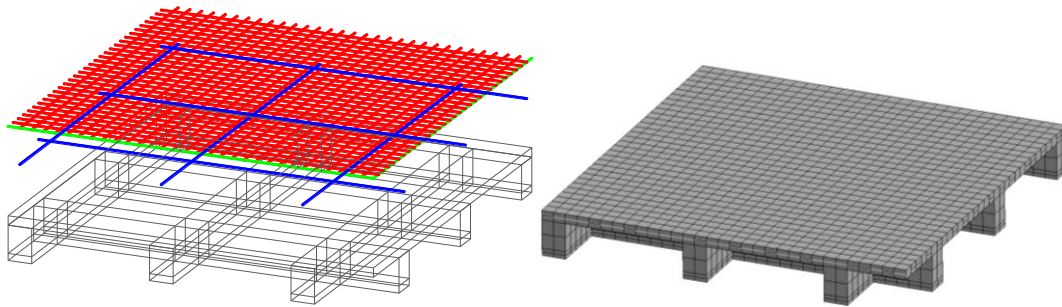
Armado y mallado de la losa encasetonada de 5x5 nervaduras
